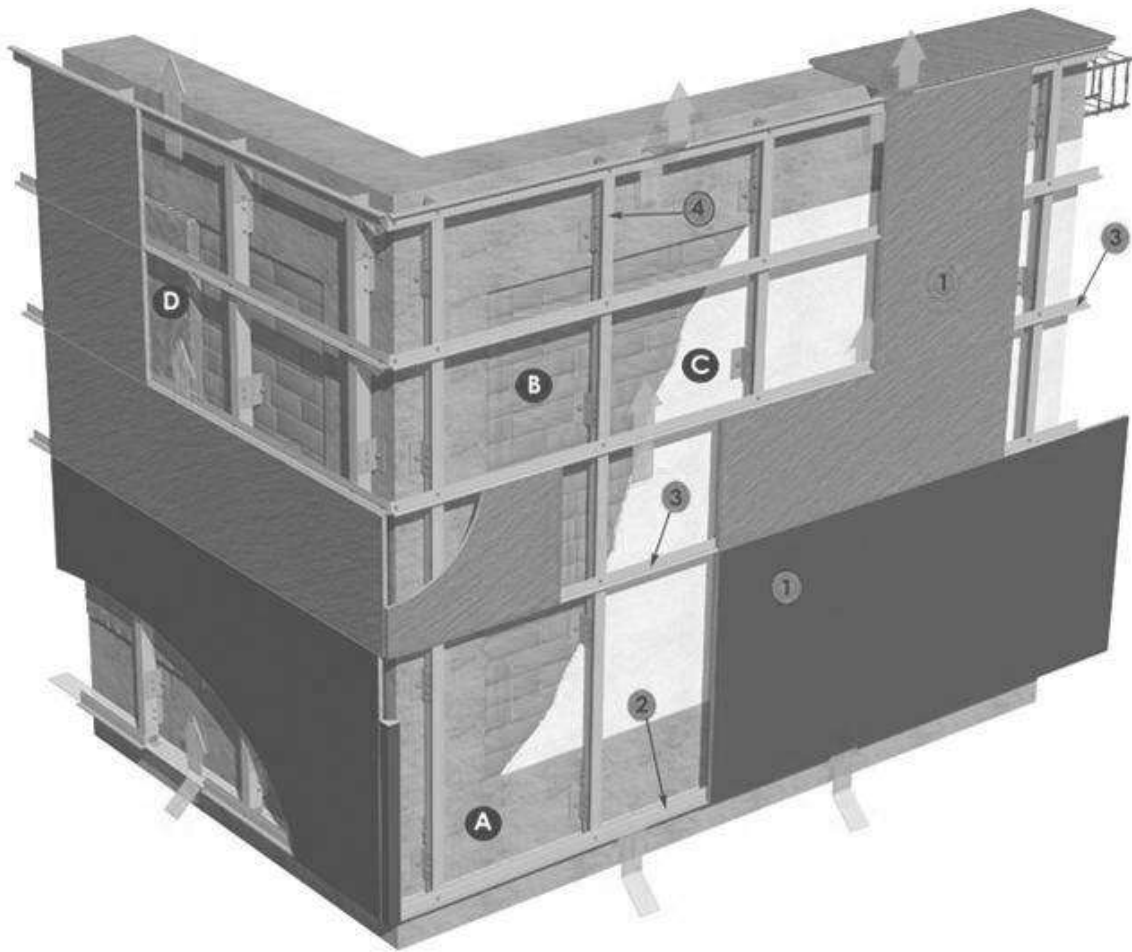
Partes de una fachada ventilada. Fuente: [www.ulmapolimero.com](http://www.ulmapolimero.com)
